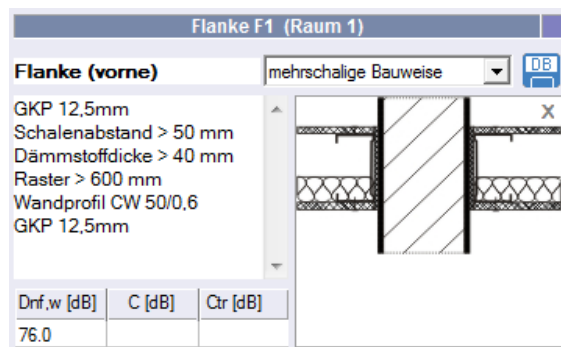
Bauteilaufbau Flanke in Raum 1 (mehrschalige Bauweise)
